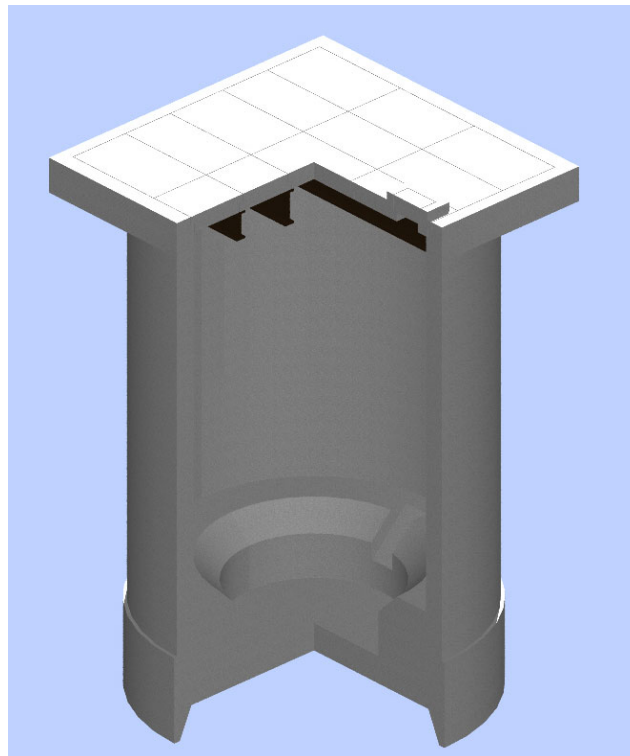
Schachtbauwerk (Betonschacht mit Abdeckung)
